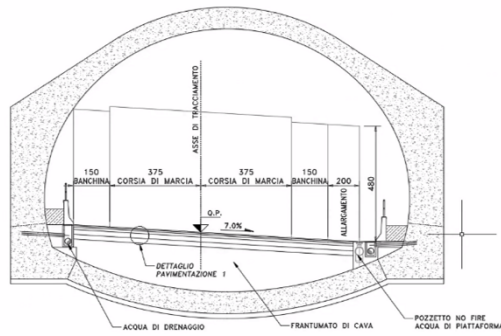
d - Sezione tipo C1 in galleria naturale Torrette 2.
